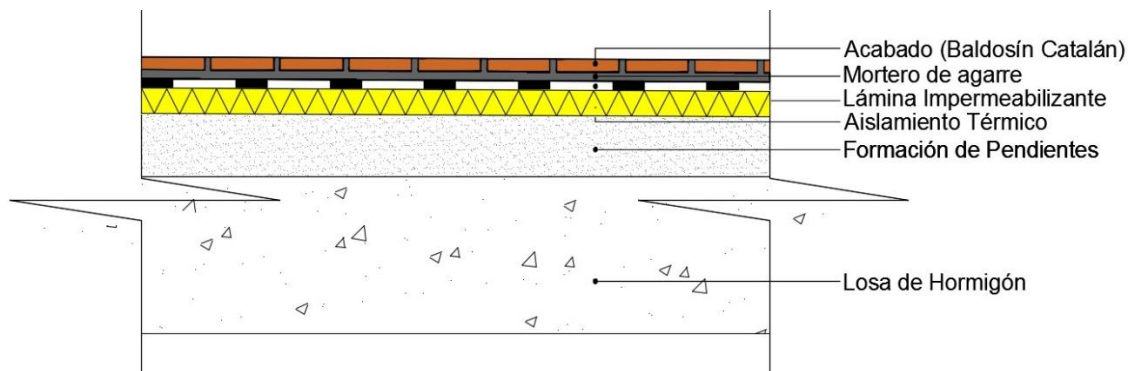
Sección constructiva del cerramiento de la cubierta de los locales comerciales con la introducción de la capa de aislamiento
